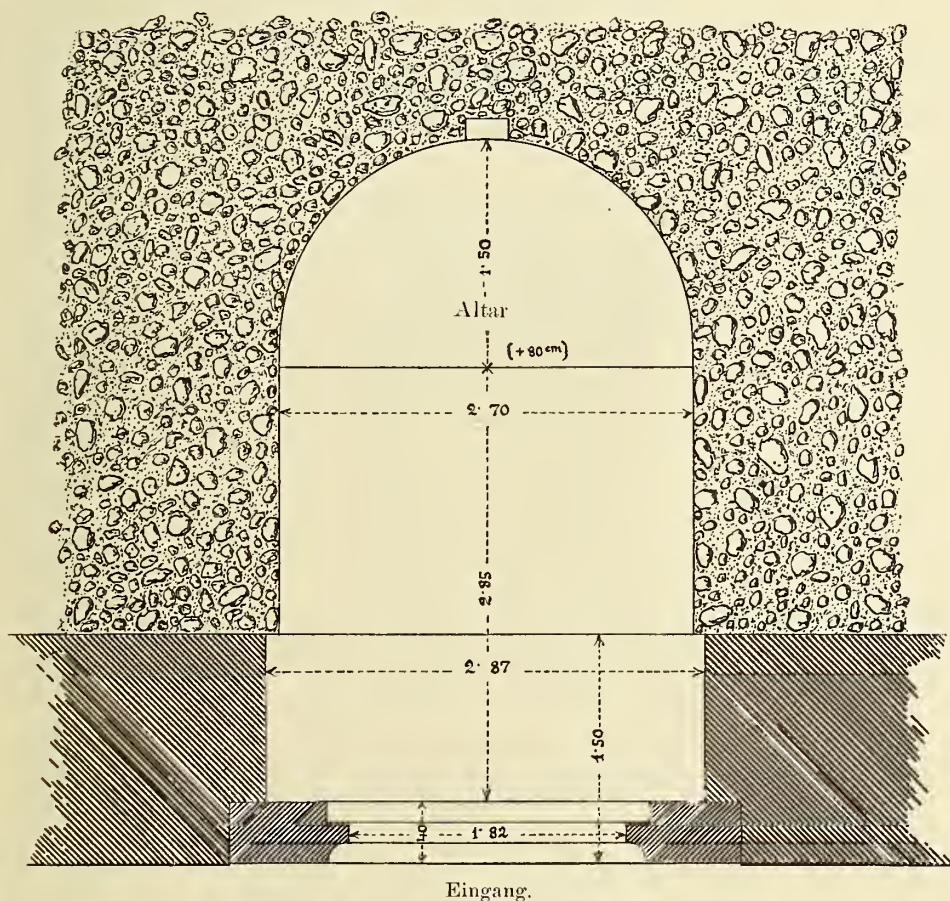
Grundriss des einstigen Pluviales in Jajce, 1 : 50.
